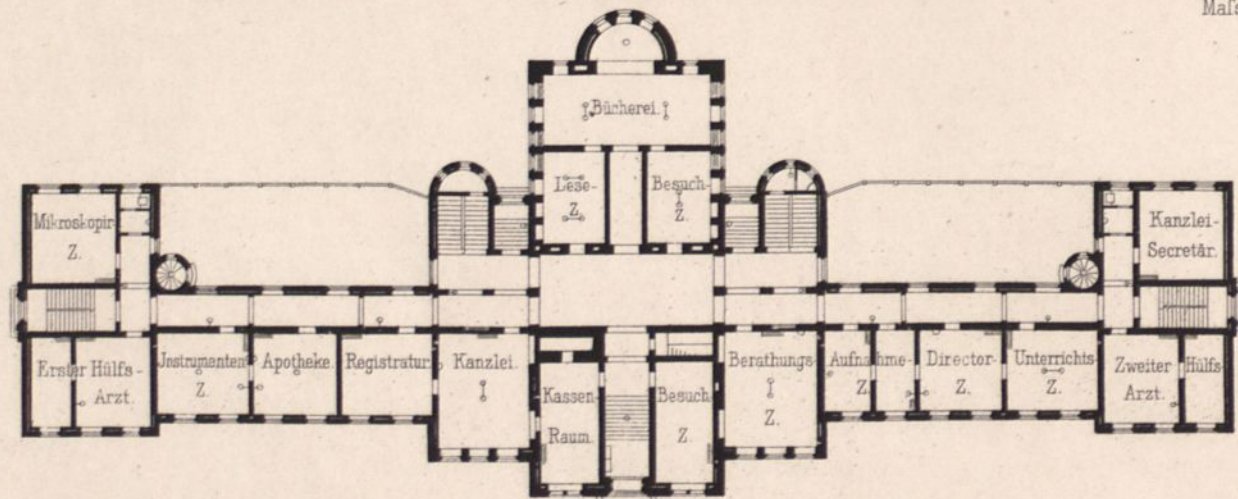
Verwaltungs-Gebäude. Grundriss des Erdgeschosses.
